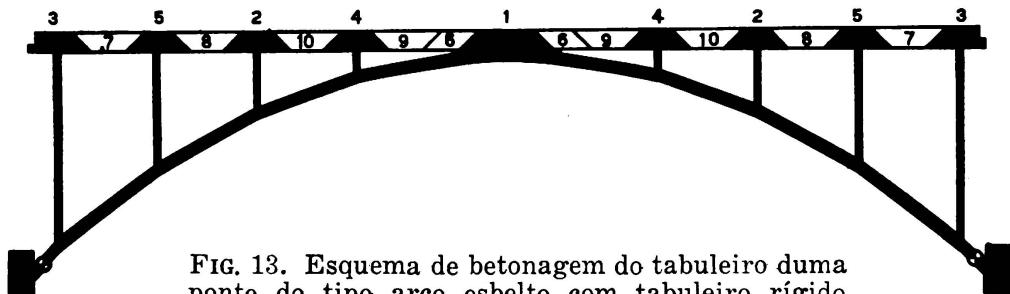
Esquema de betonagem do tabuleiro duma ponte do tipo arco esbelto com tabuleiro rígido
